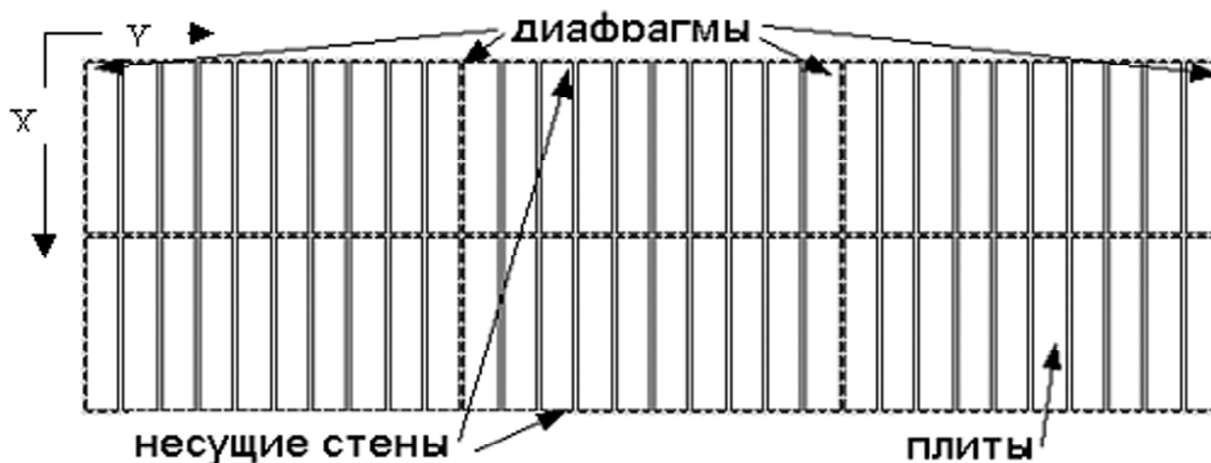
Каменное здание с поперечной раскладкой плит перекрытия
